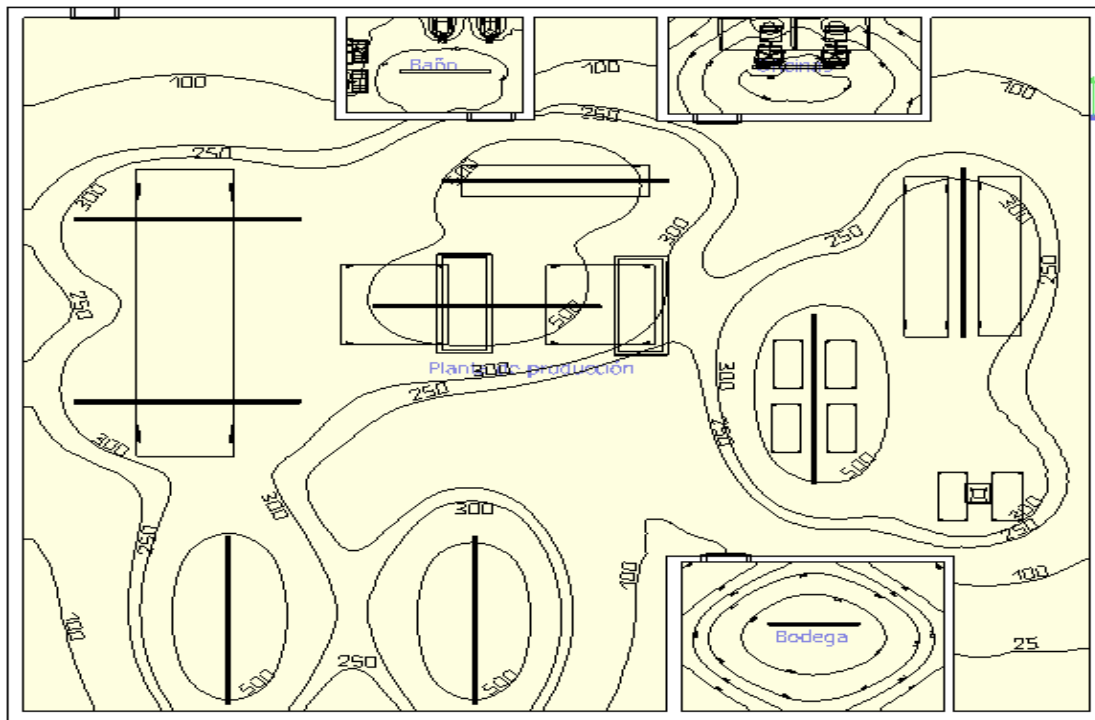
Layout propuesto con la iluminación adecuada en cada área de producción en la planta textil.
